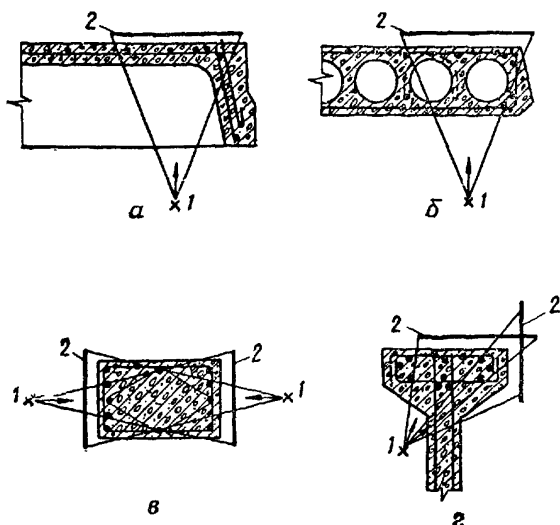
Схемы просвечивания железобетонных конструкций:
